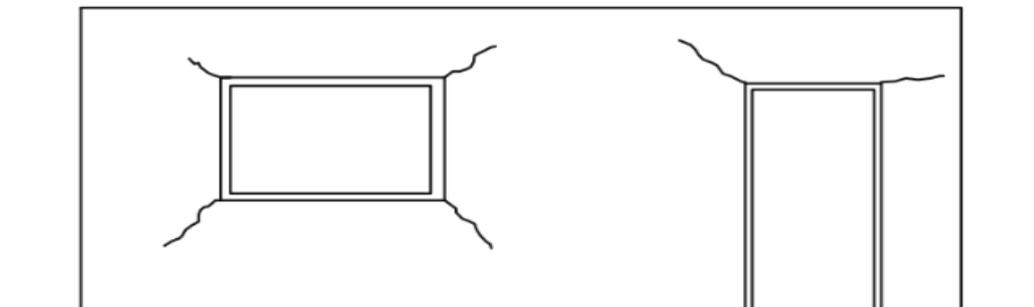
Fissuração em torno de aberturas em parede submetida a sobrecarga.
